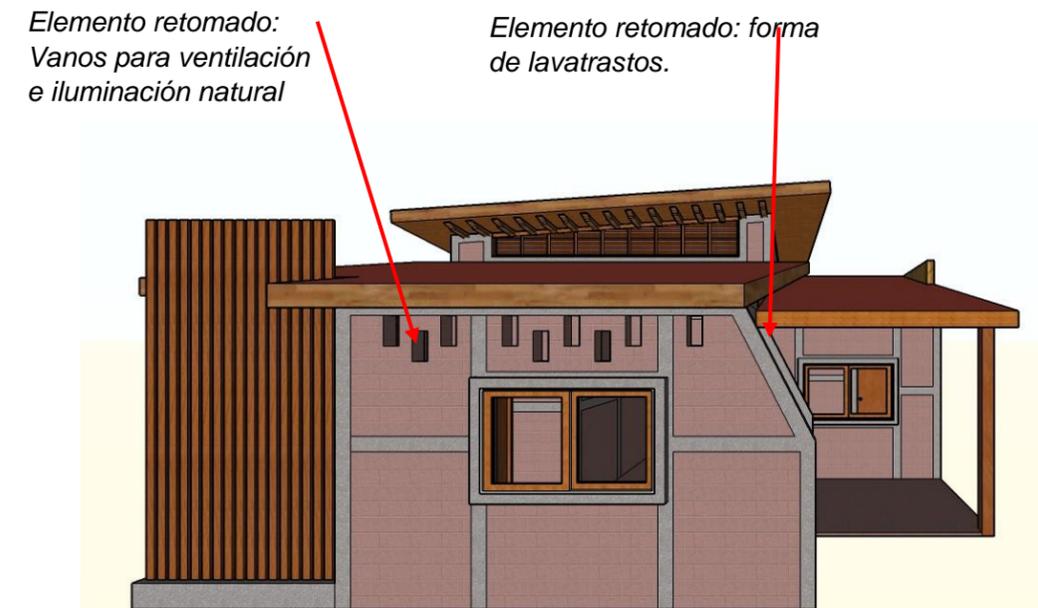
Elevación 2 de propuesta de vivienda bioclimática con elementos de identidad. Fuente: equipo de trabajo
